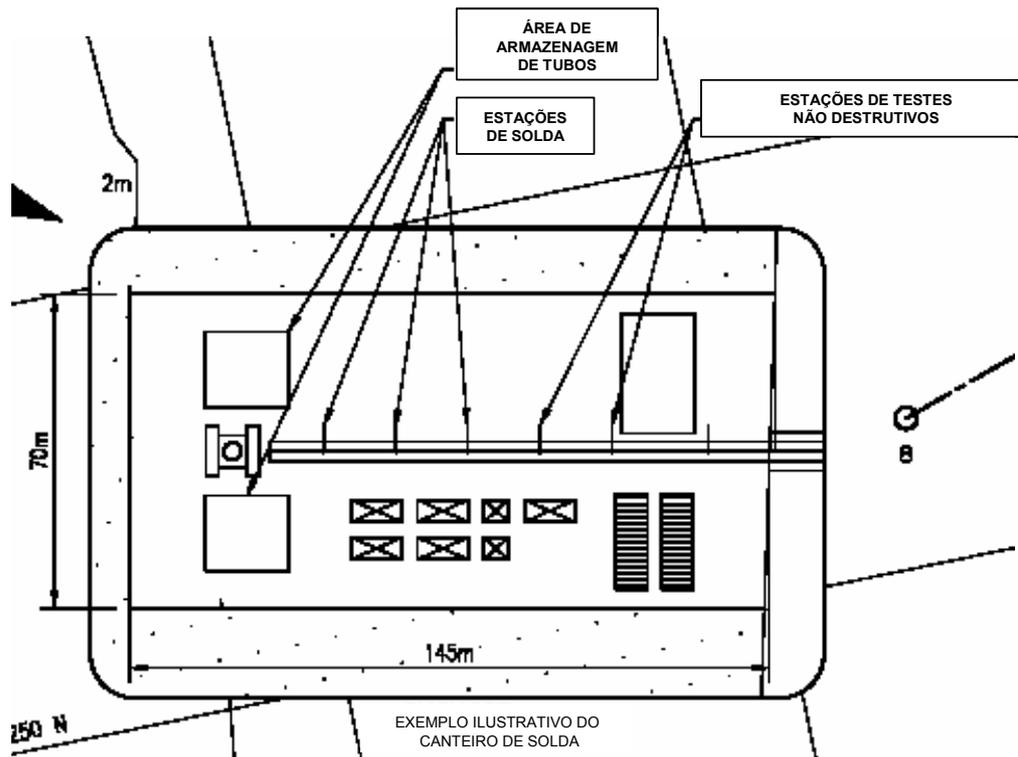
Esquemático ilustrativo do canteiro de solda.
